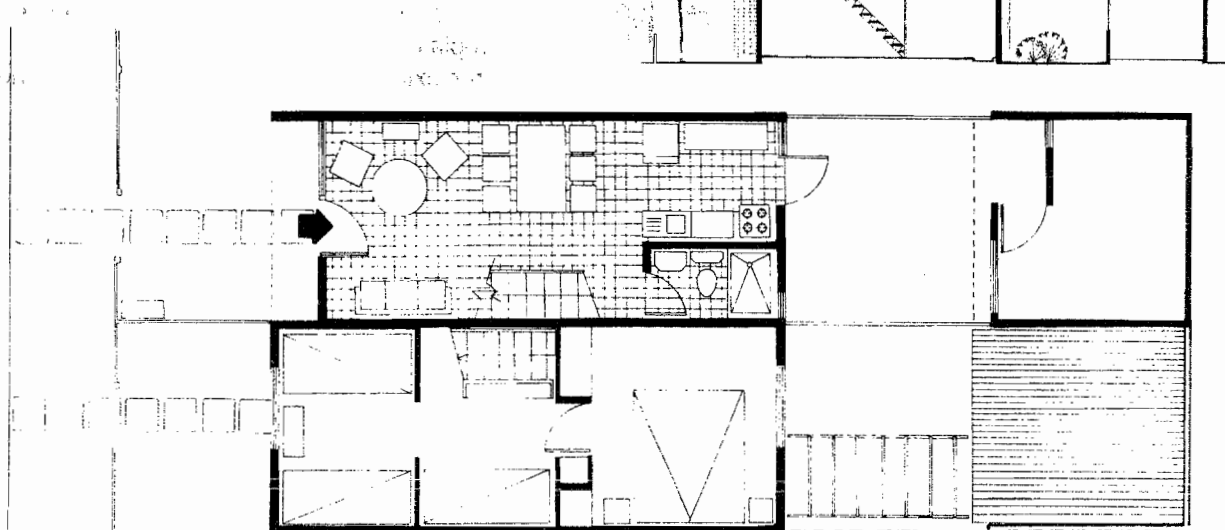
Prototipo de Vivienda Social construida por Empresa Constructora ARQUIN Ltda.
